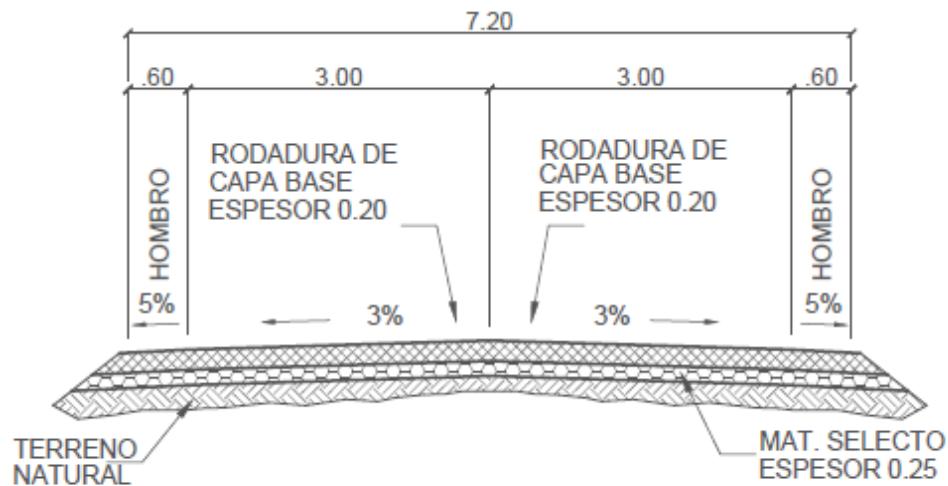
Detalle típico de la calle de 7.20 m, con rodadura de Concreto
